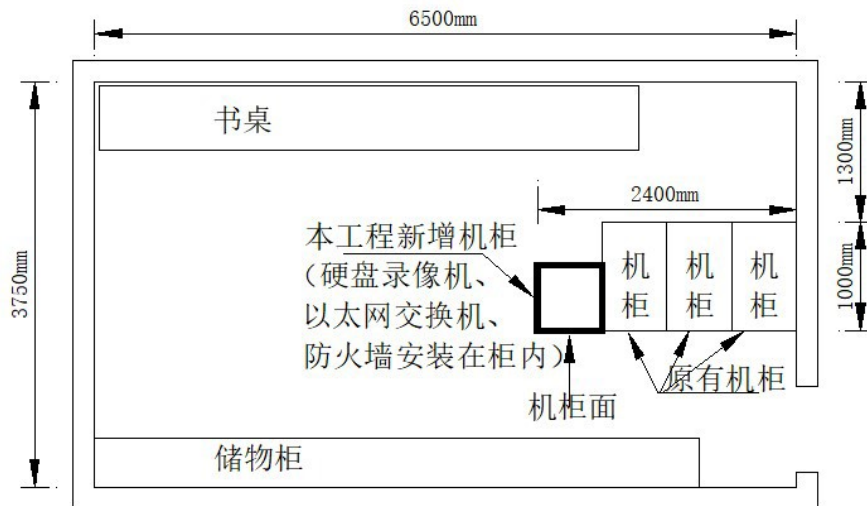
五指山市水务局 2 楼机房设备安装平面图
